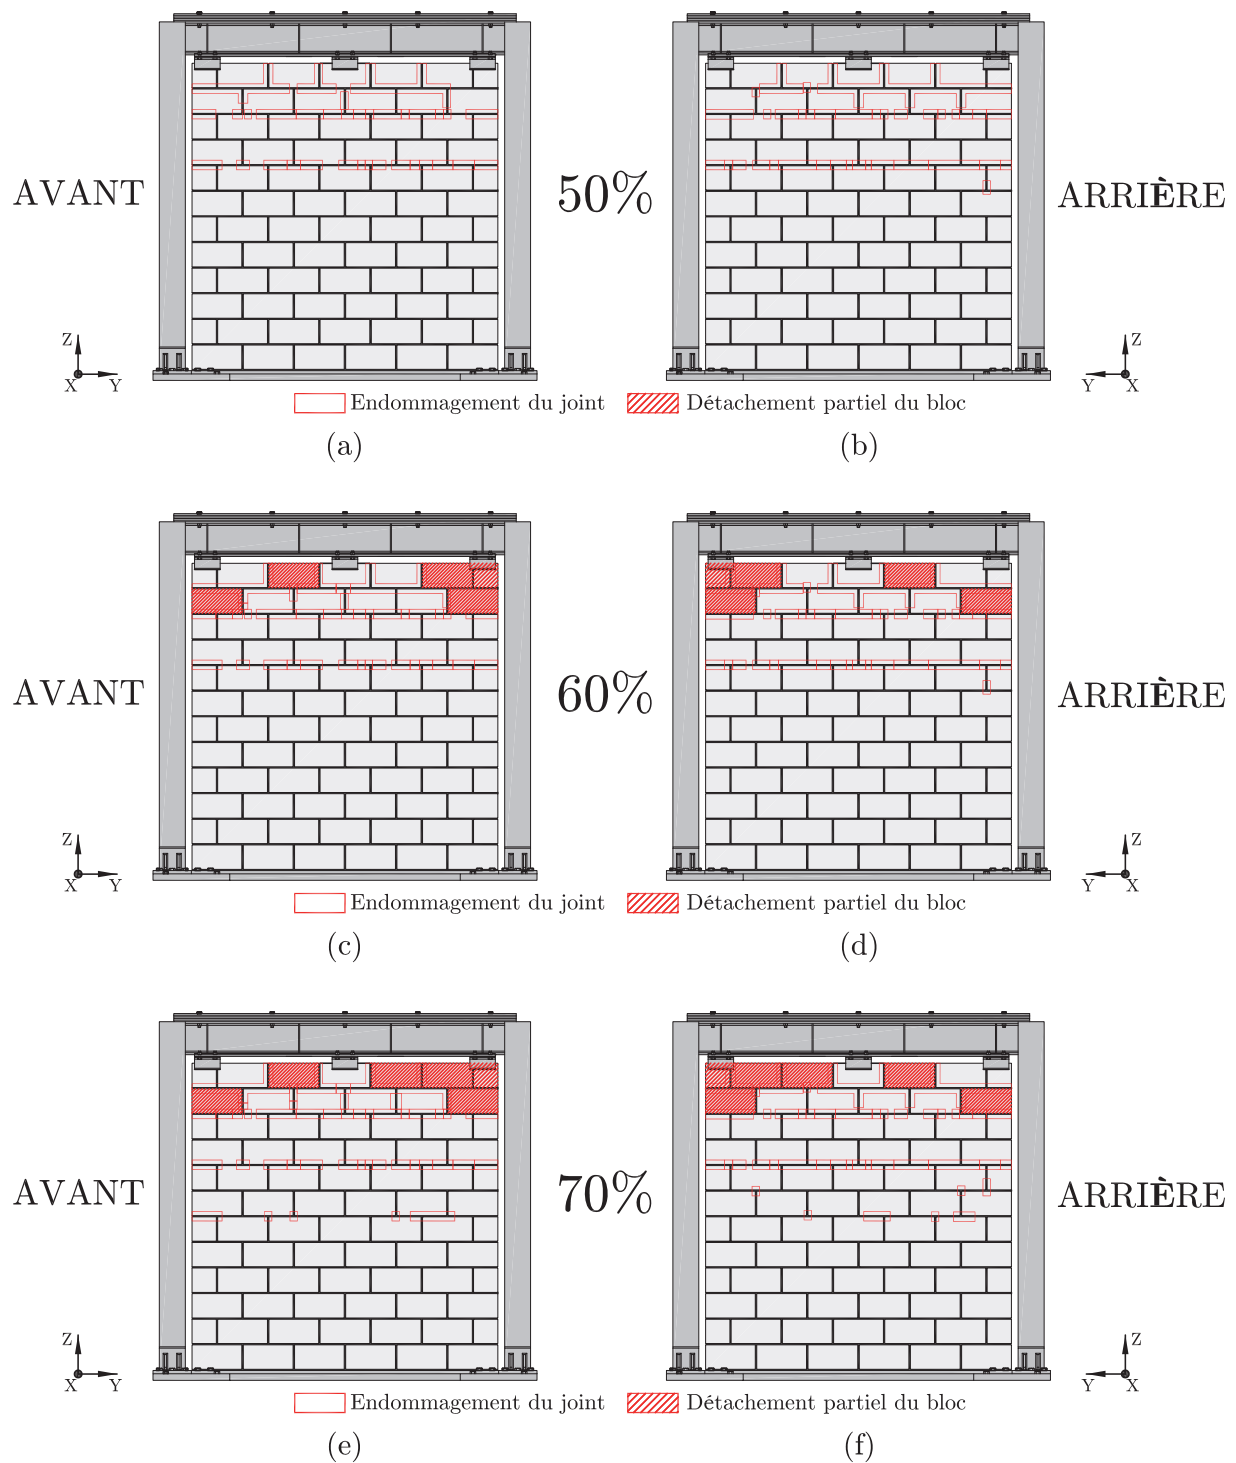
Représentation visuelle de l'endommagement du mur 2 après l'essai (a) MAL10-0.50 - façade avant (b) MAL10-0.50 - façade arrière (c) MAL11-0.60 - façade avant (d) MAL11-0.60 - façade arrière (e) MAL12-0.70 - façade avant (f) MAL12-0.70 - façade arrière
